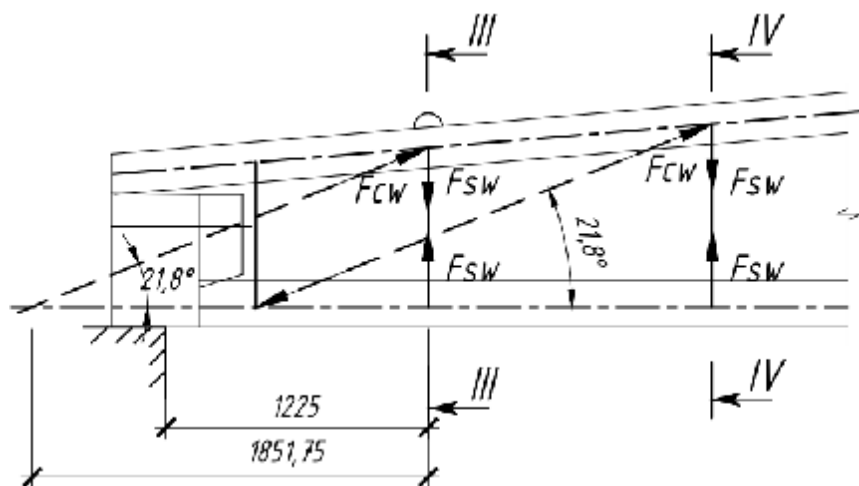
Схема заменяющей фермы с подкосами при расчете наклонных сечений в сечении баки.
